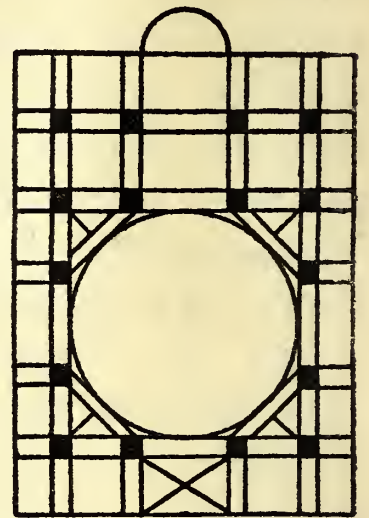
S. Stephan Walbrook, London. Grundriß.
